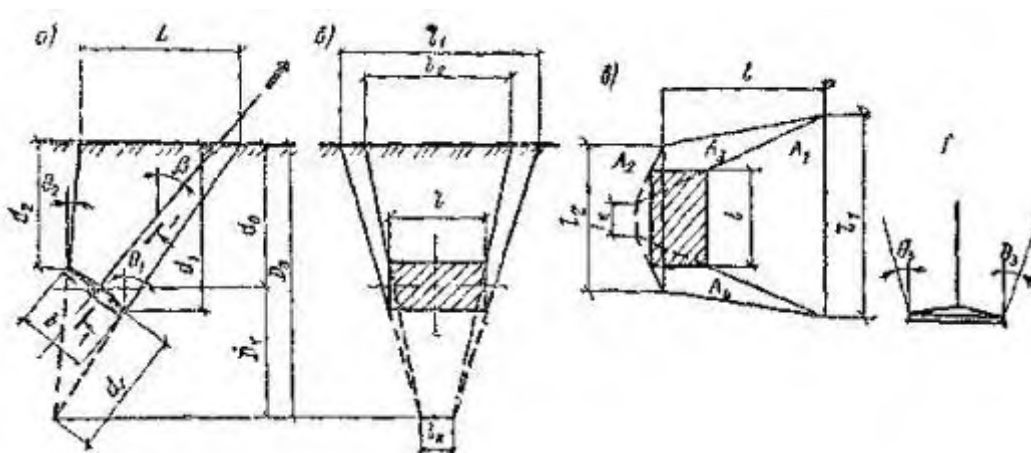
Схема к расчету анкерных плит по устойчивости при выдергивании
